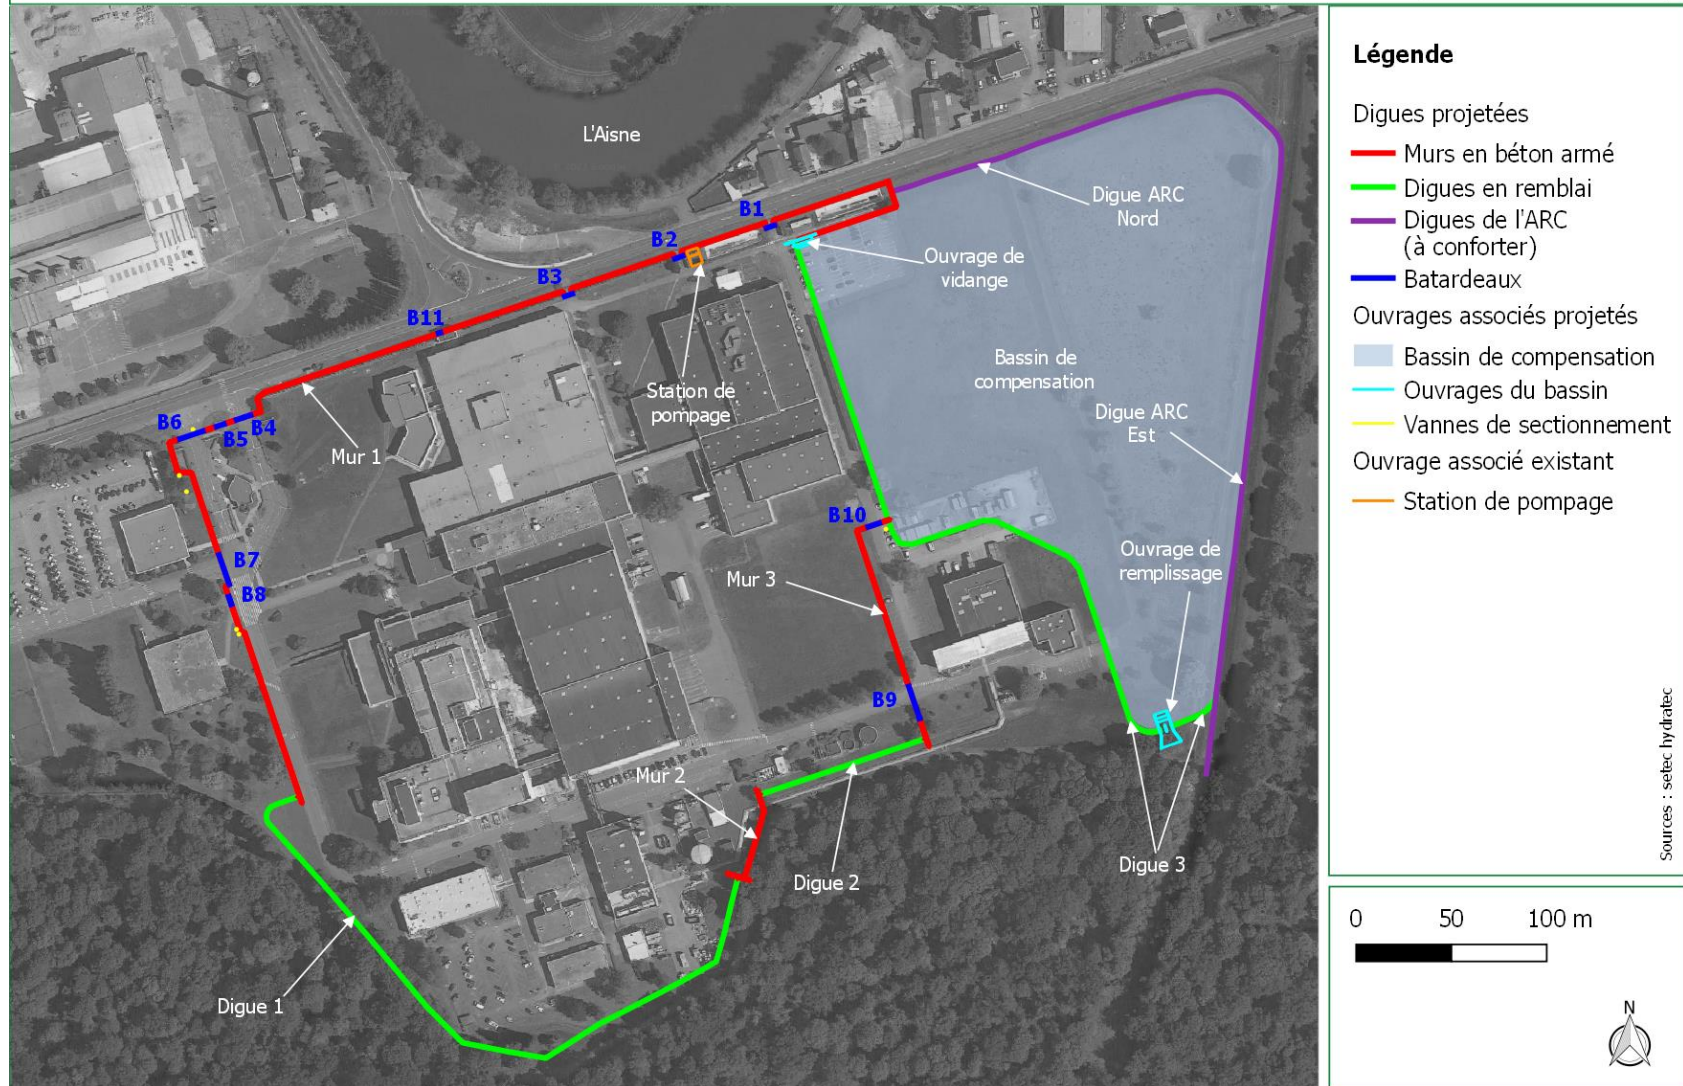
Plan du système d'endiguement – Source : Setec Hydratec
